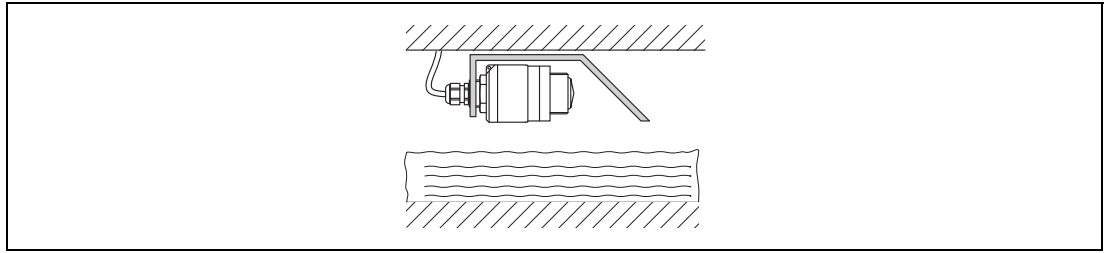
Montage horizontale Montagehalterung Abwasserschacht
